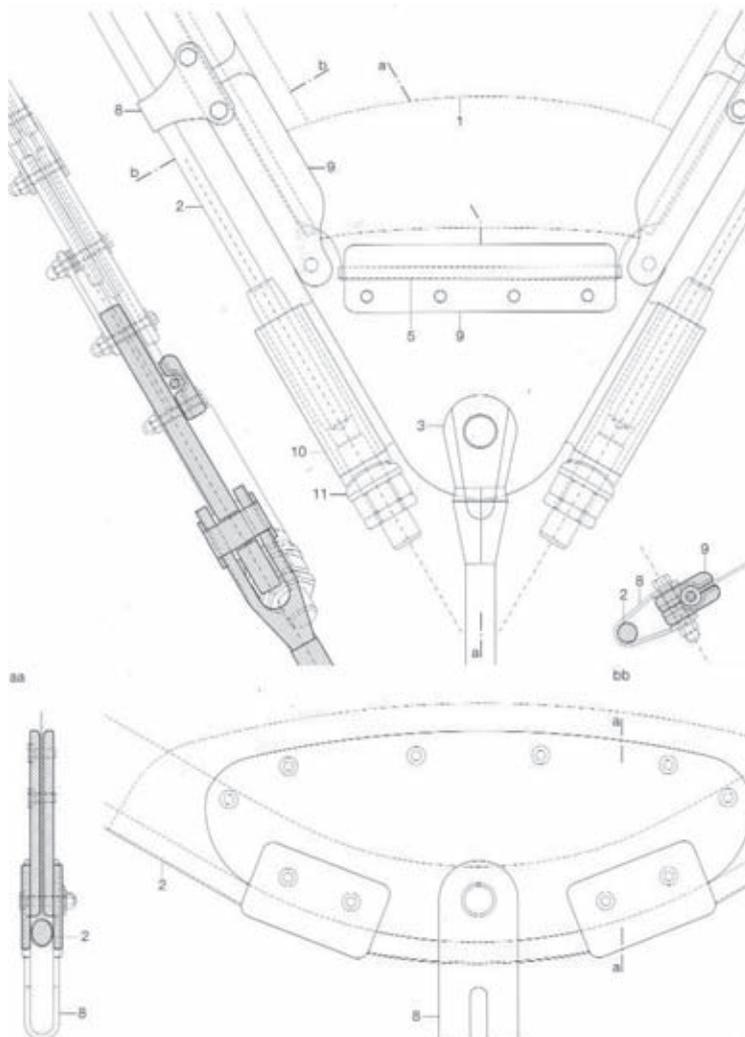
geschlossene Membranecke mit durchgehendem Randseil
